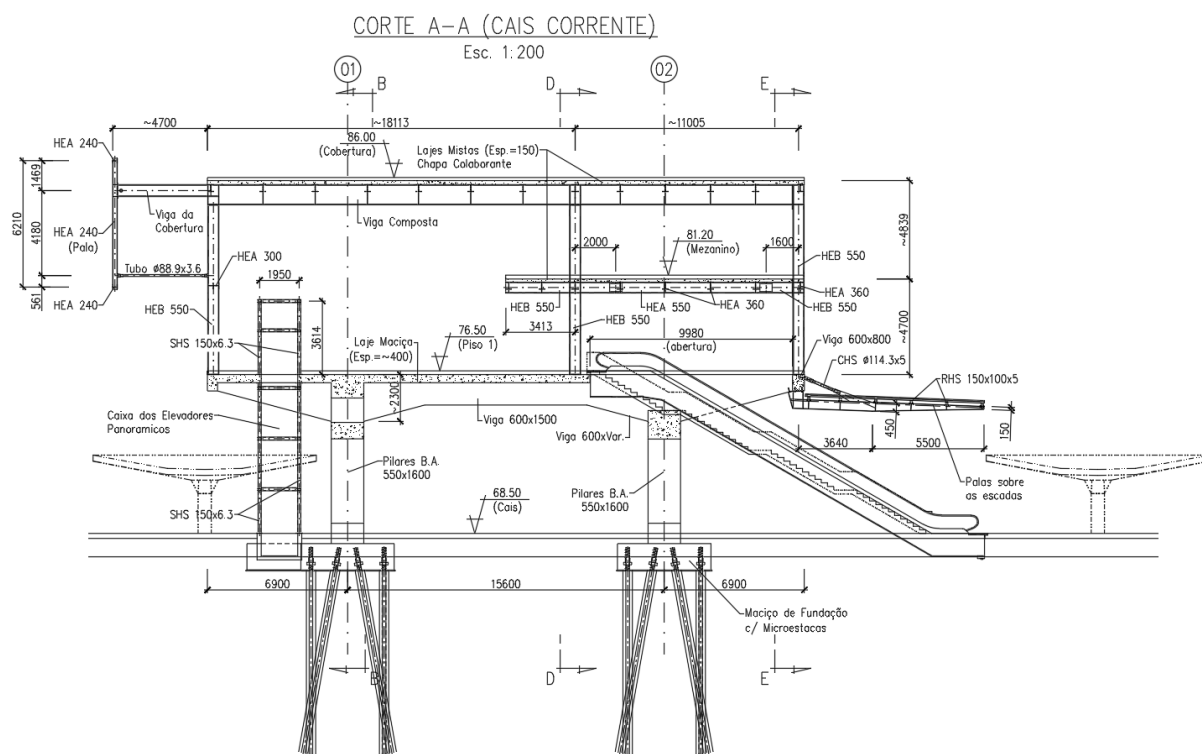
Edifício Ponte: Corte transversal cais corrente.
